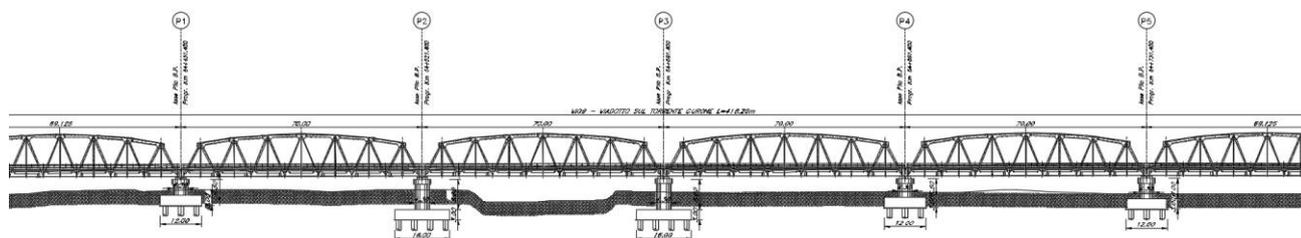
Torrente Curone: sezione/prospetto dell'opera di attraversamento in progetto.
